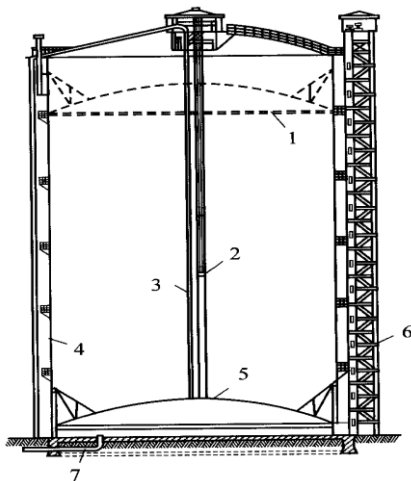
Схематическое изображение конструкции сухого цилиндрического газгольдера низкого давления:
